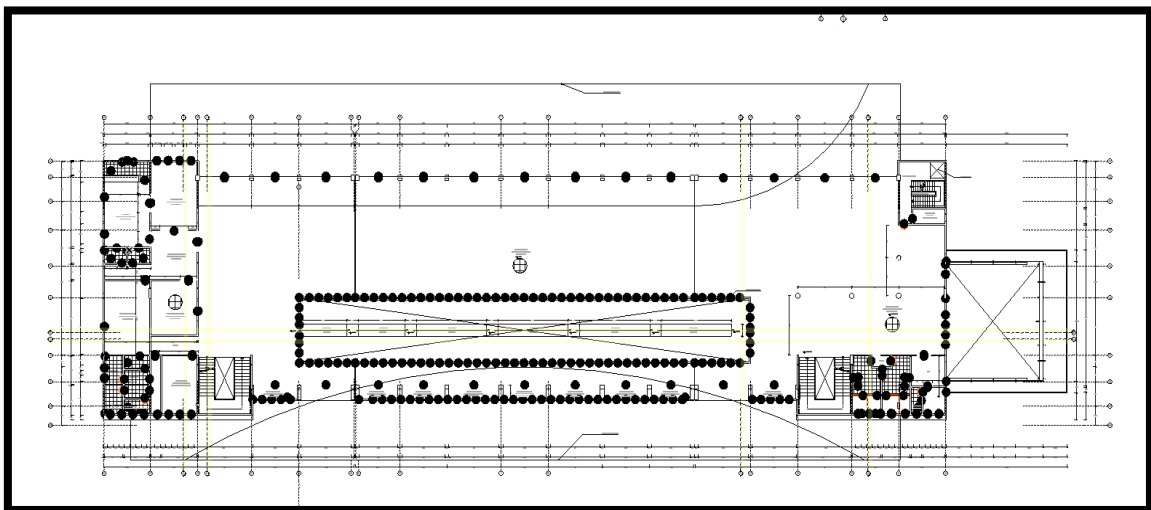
Planimetría del segundo nivel (fuente expediente técnico)
